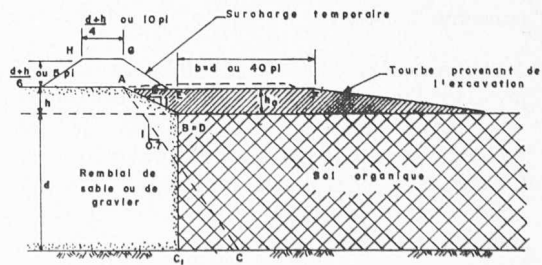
Sections types pour l'excavation des matériaux compressibles, recommandations de Casagrande (1966).
